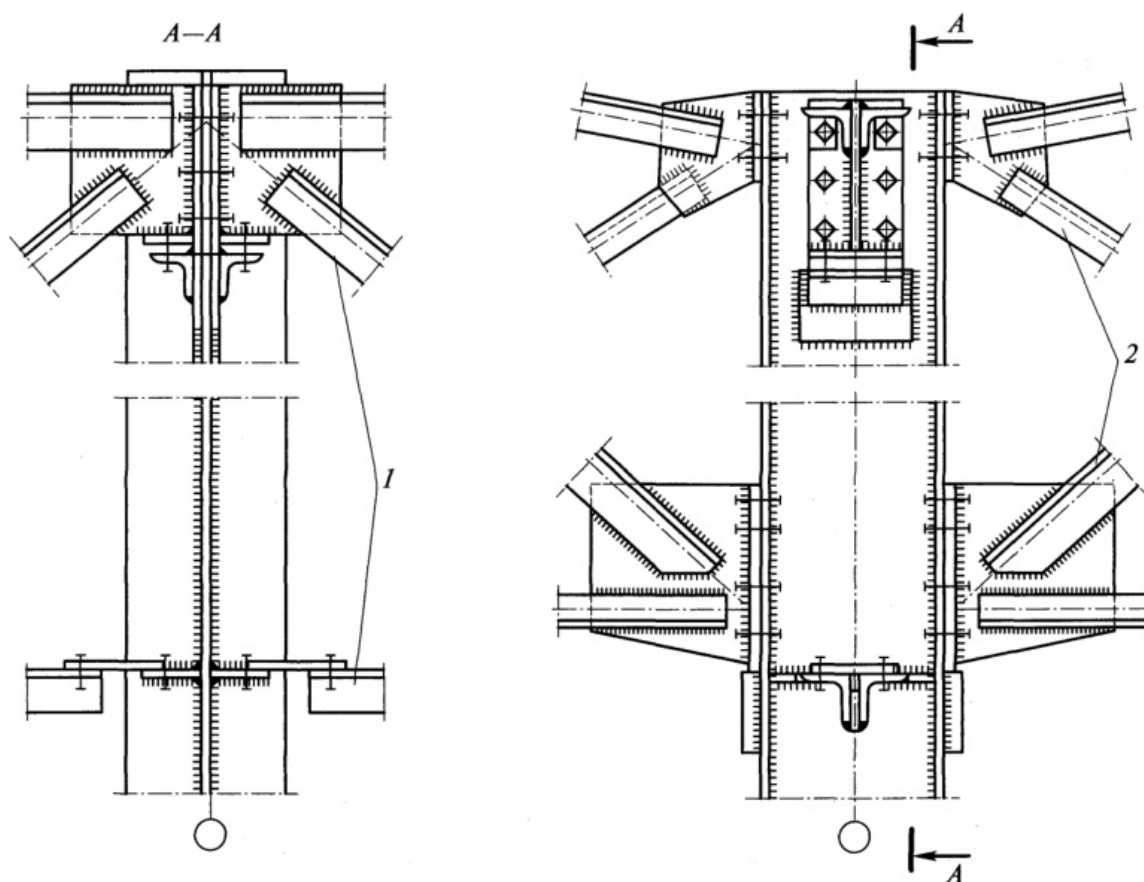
Узел опирания подстропильной фермы на колонну:
